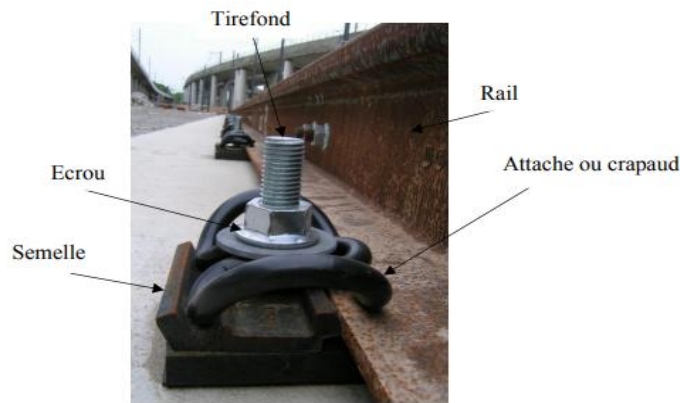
Fixation du rail Vignole sur traverse en béton.
